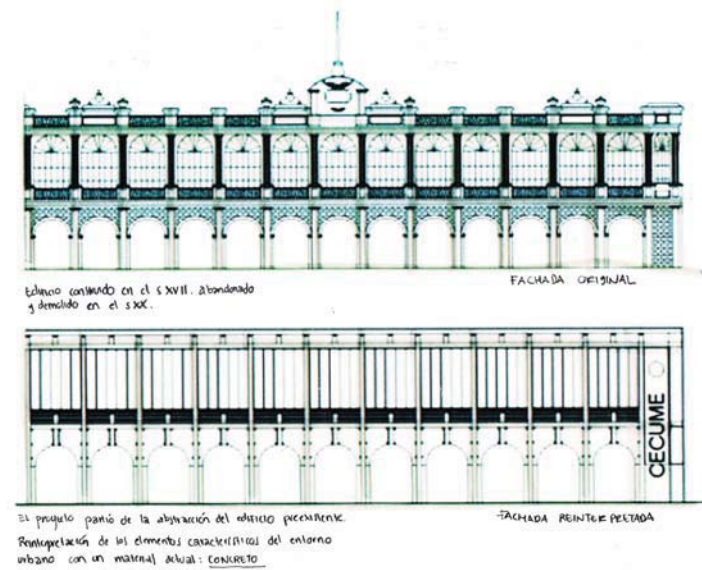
y 46 Análisis de fachada y emplazamiento del proyecto.
